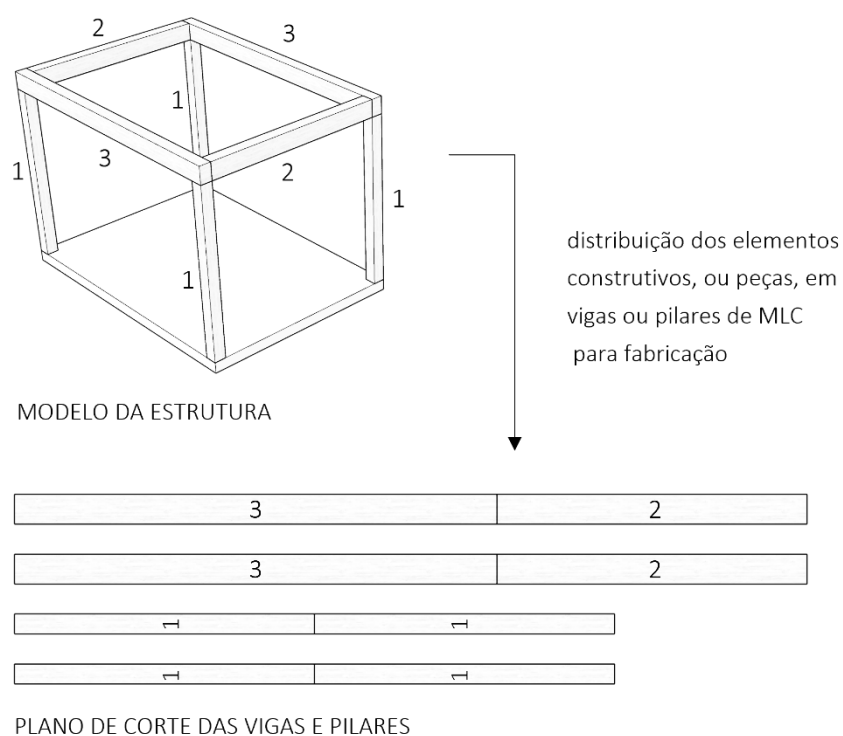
Esquema ilustrando o planejamento do corte de pilares e vigas de MLC.
